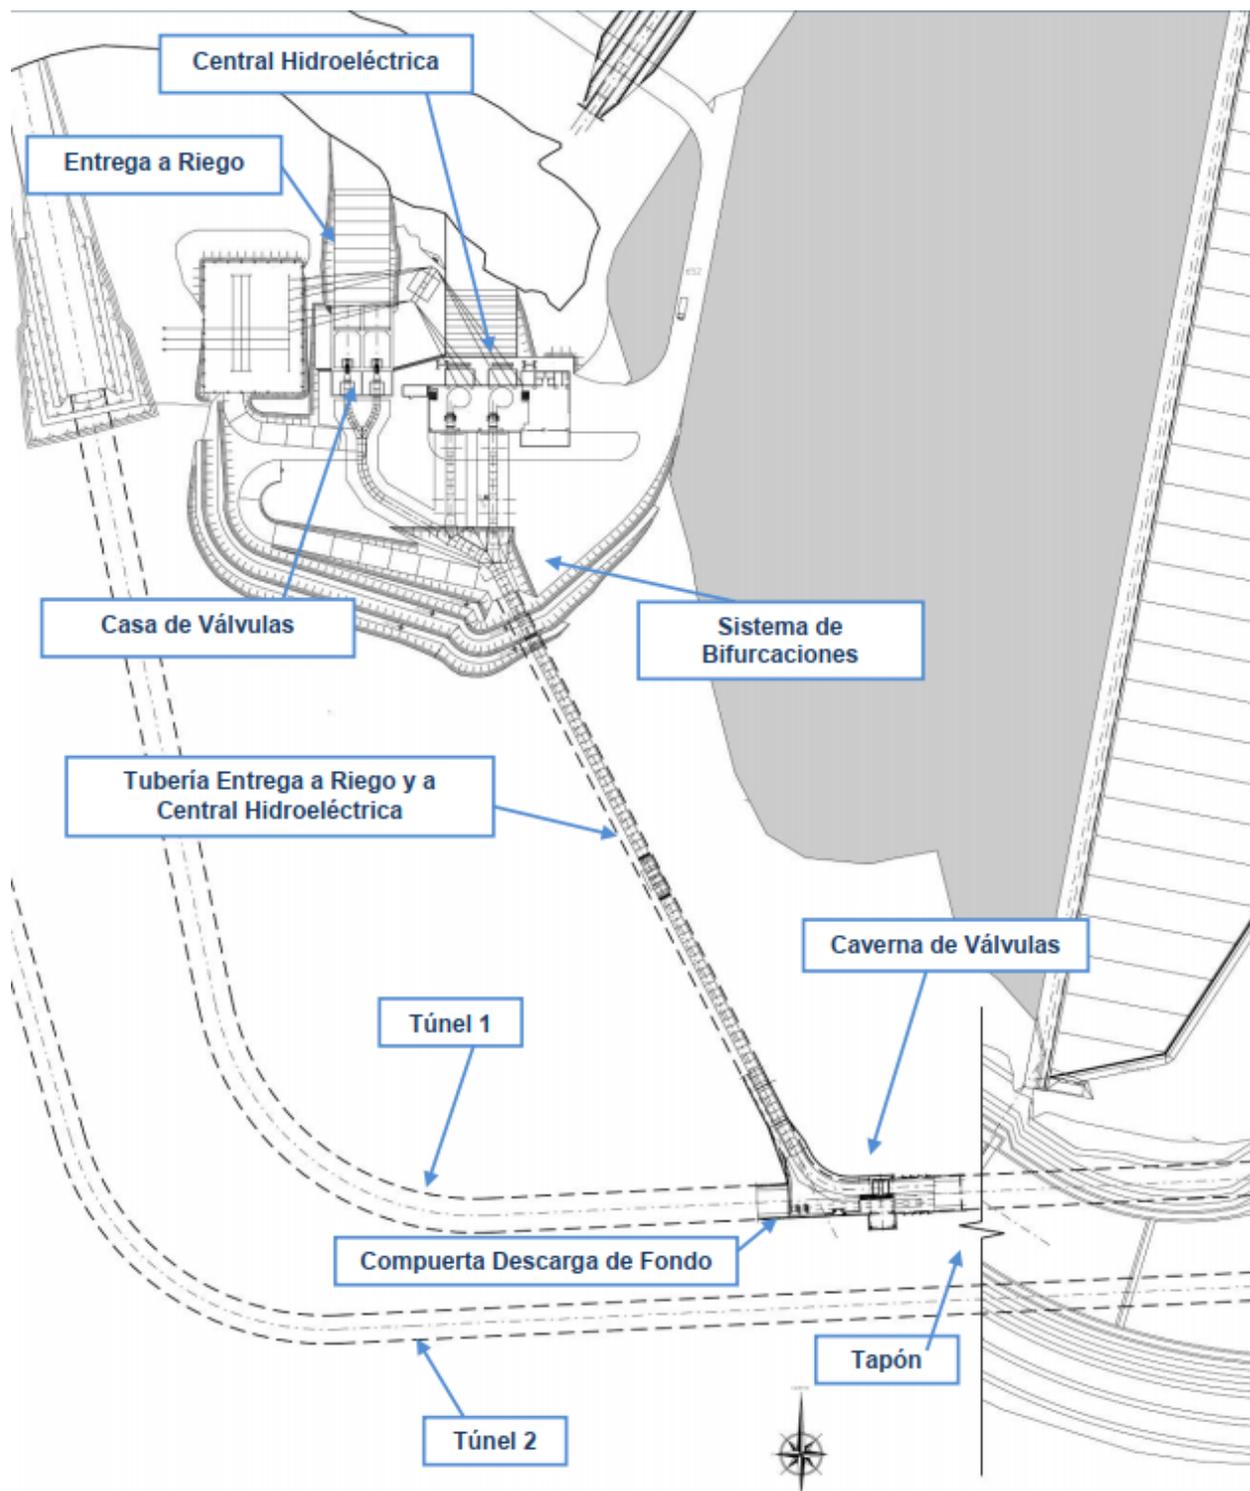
Vista en planta de las obras de entrega a riego y generación eléctrica. Fuente: Astaldi (2015).
